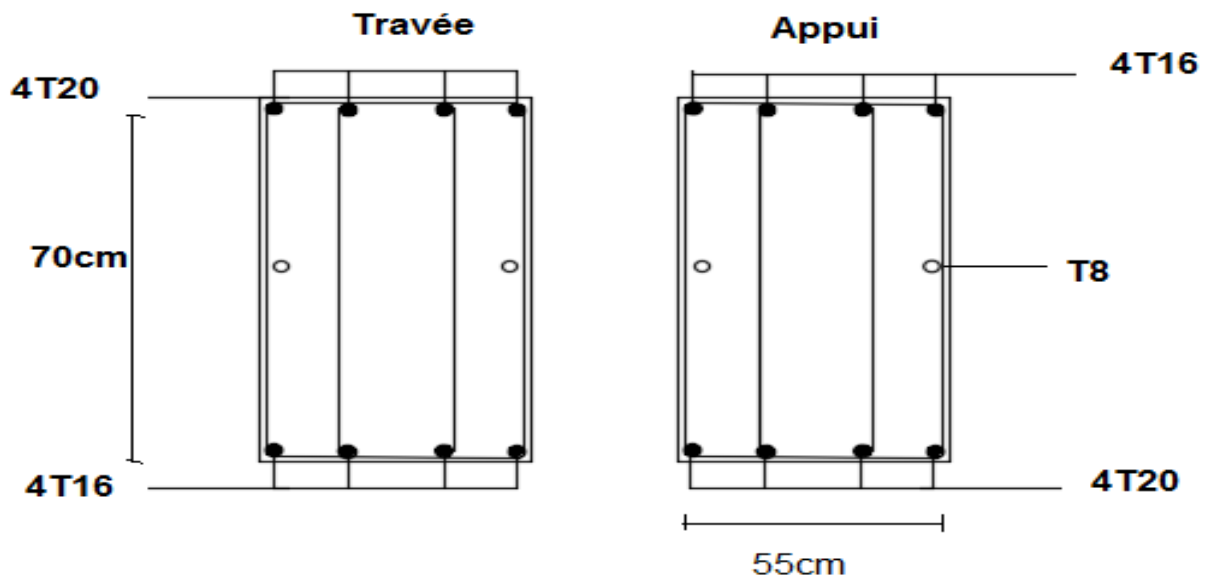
Schéma de ferrailage des nervures (sens porteur)
